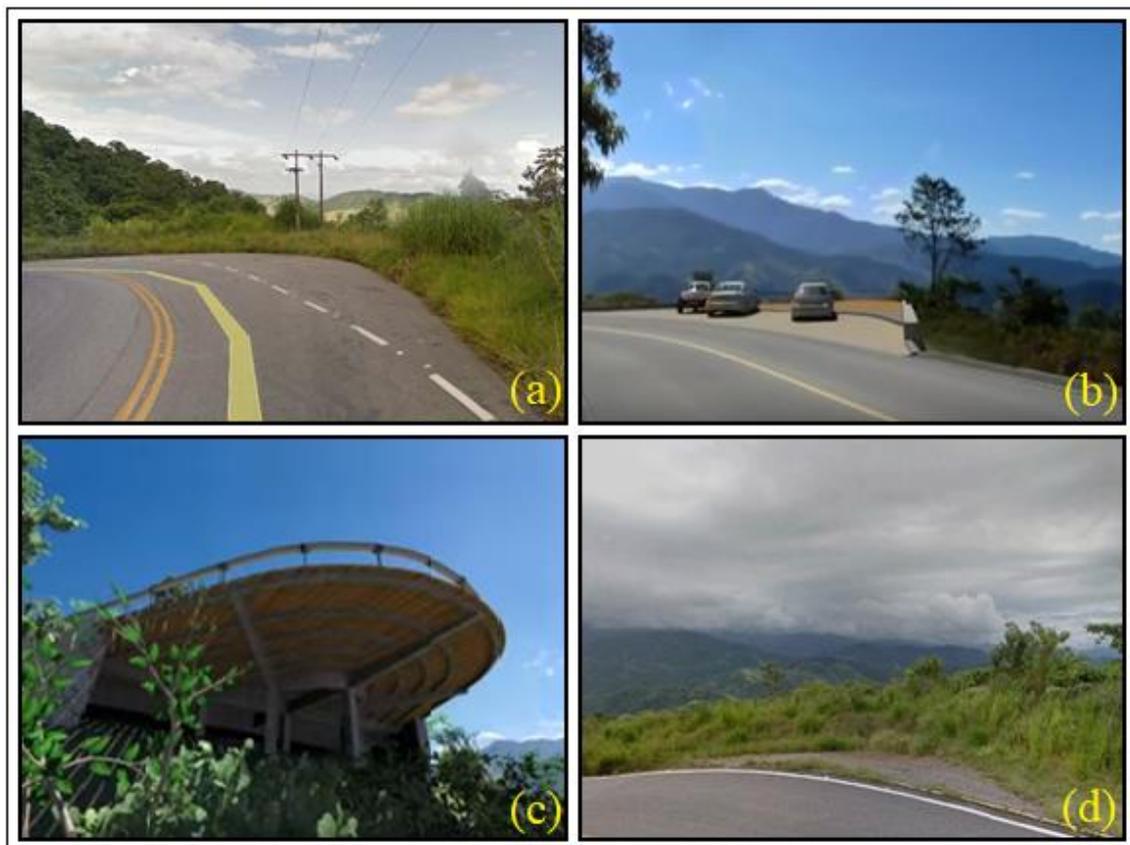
Mirantes do Rio Pirapetinga e do Rio Preto. a) área onde seria o mirante do Rio Pirapetinga. fonte: Google Earth (2016); (b) e (c) projeto do mirante do Rio Preto. fonte: INEA (2018); d) área onde seria o mirante do Rio Preto em janeiro de 2017.
